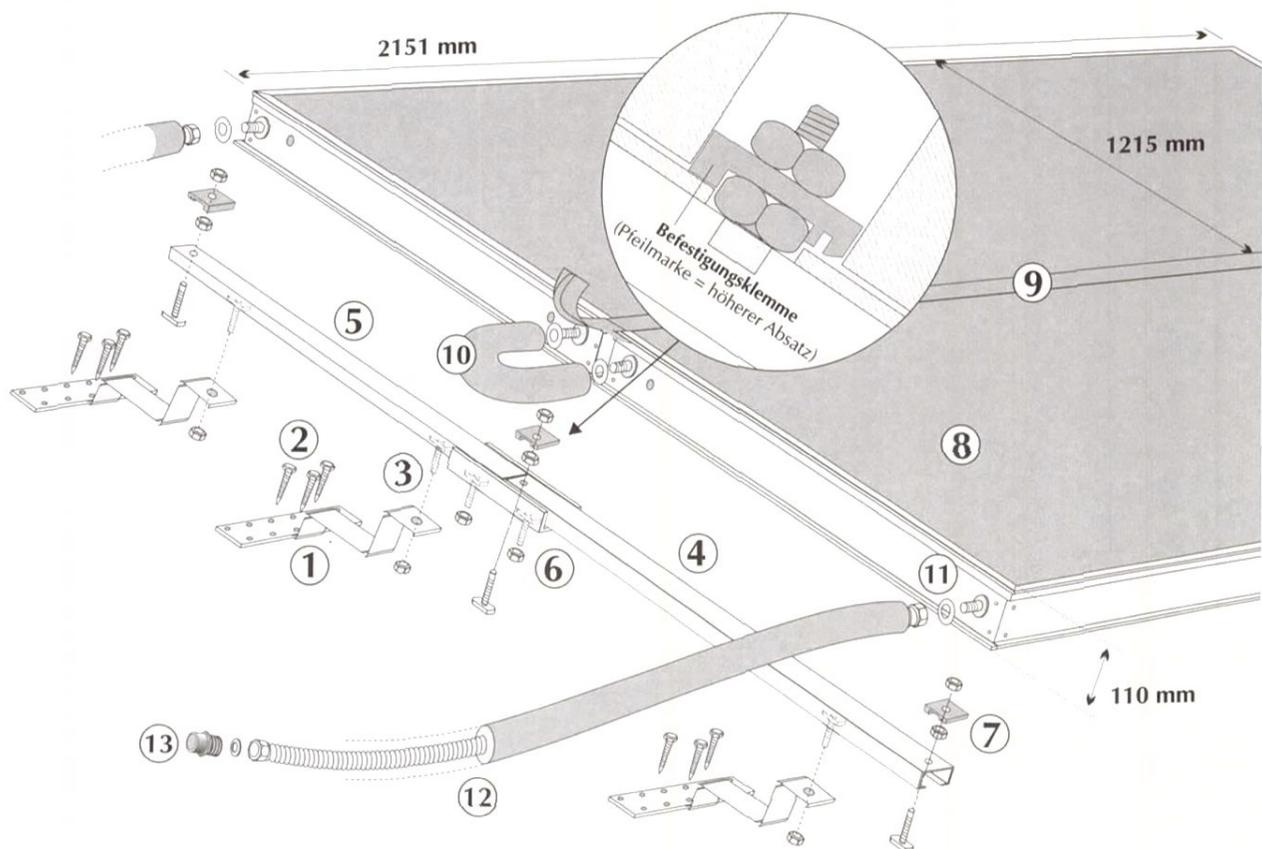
Grundmodul VFK-Kollektor-Aufdachmontage für waagrechte oder senkrechte Kollektoranordnung (hier am Beispiel der waagrechten Kollektoranordnung): 1 Sparrenanker, 2 Schnellbau-Schrauben 6x80, 3 Hammerkopfschraube M10x30 mit Mutter, 4 Grund-Montageschiene 1257 mm lang, 5 Erweiterungs-Montageschiene 1223 mm lang, 6 Kupplungsstück mit Hammerkopfschrauben aus Edelstahl M10x30 mit Mutter, 7 VFK-Befestigungsklemme mit Hammerkopfschraube M10x30 und zwei Muttern, 8 VFK-Kollektor (nicht Bestandteil des Grundmoduls), 9 Abdeck-T-Profil aus Silikon, 10 Edelstahlwell-schlauch mit Überwurfmutter 1/2" und Isolierung 20x13 mm, 235 mm lang, 11 Dichtungsring, 12 Edelstahlwell-schlauch mit Überwurfmutter 1/2" und Isolierung 20x13 mm, 900 mm lang, 13 Löt-nippel 1/2"/18 mm.
